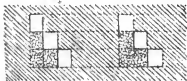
Section transversale des tailles dans les ouvrages en travers.
